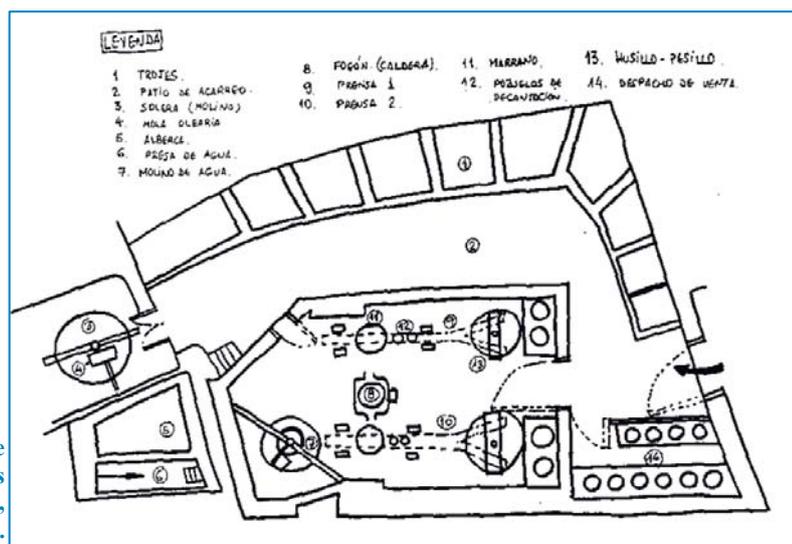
Planta tipo de almazara existente entre los siglos XV y XX (Rojas-Sola, et al., 1996).
